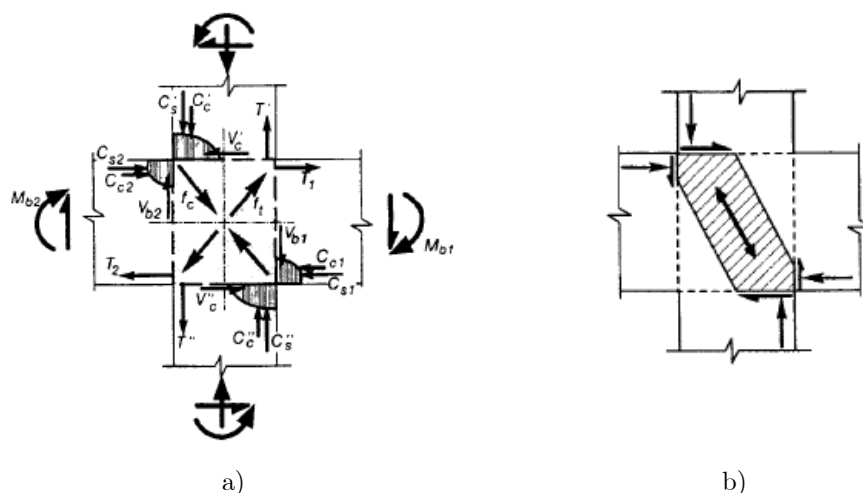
Nó viga-pilar interior submetido a uma carga lateral , adaptado de Hakuto et al. (2000): a) esforços atuantes nas vigas e pilares; b) mecanismo de escora, equilíbrio das forças de compressão do betão nas vigas e pilares.
